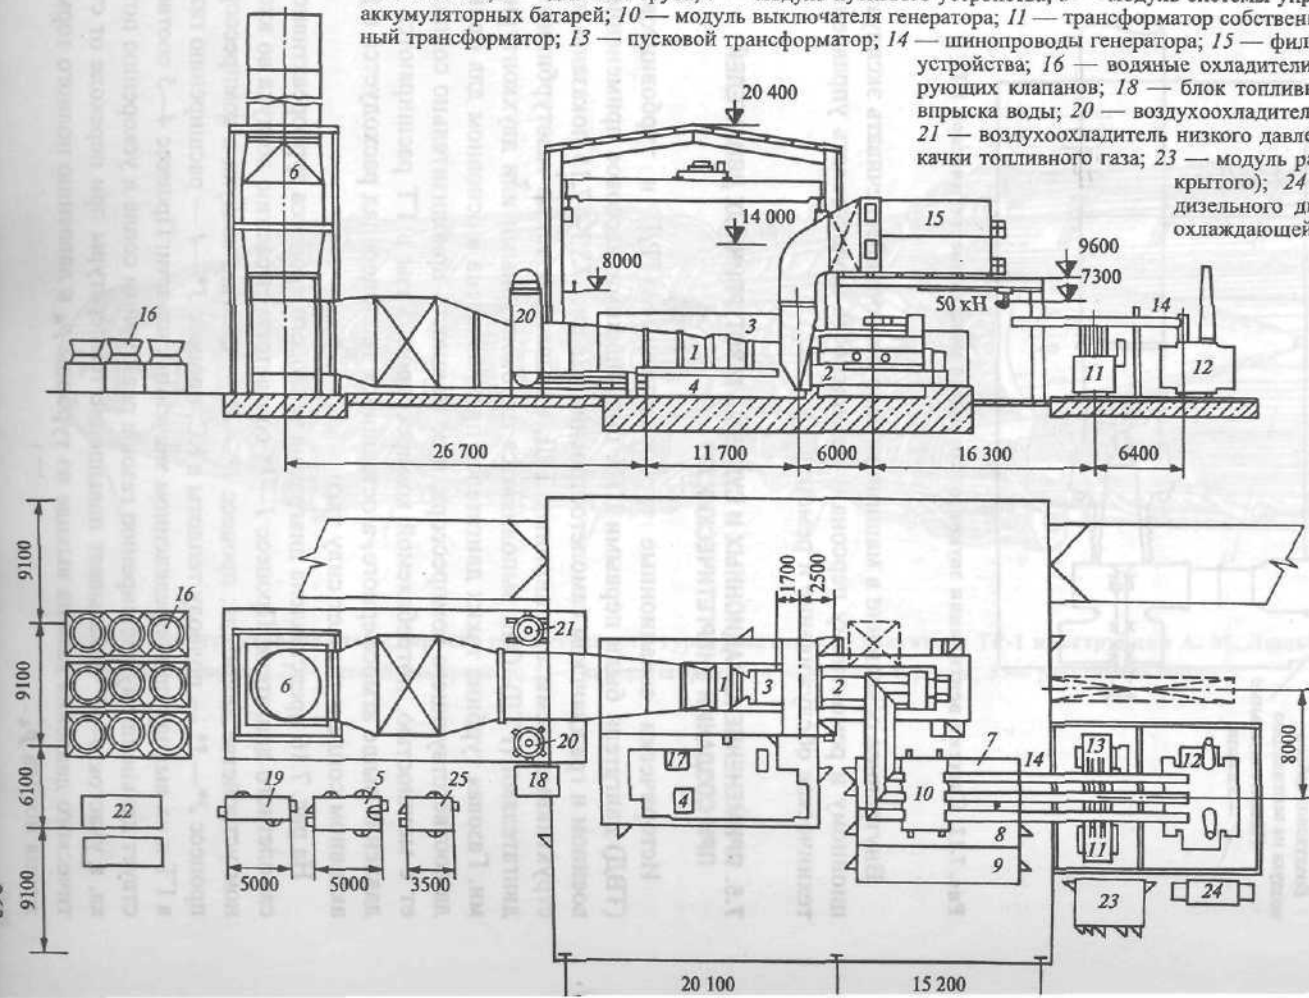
Стандартная закрытая компоновка главного корпуса газотурбинной ТЭС
